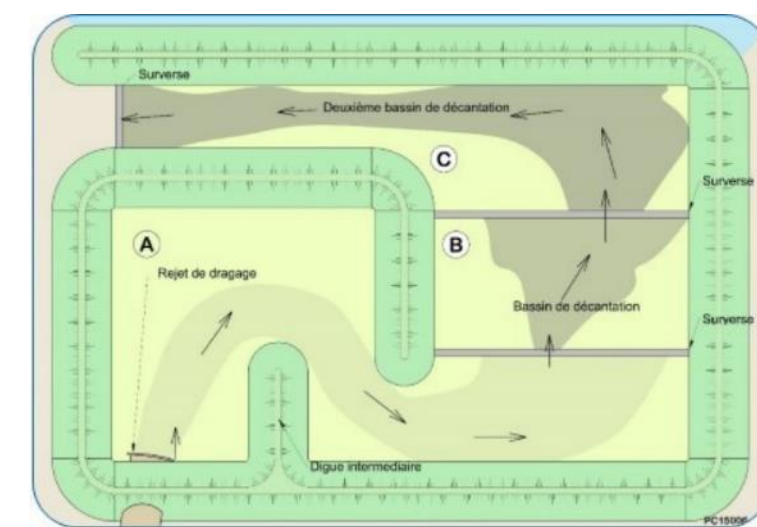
Aménagement d'un dépôt de dragage par palliers (Source illustration : AVP – TEAM'O+, 2018)
